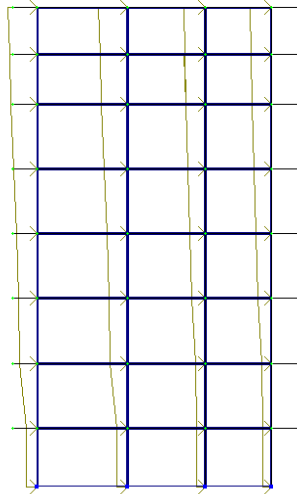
Схема вітрового навантаження на поперечну раму,
